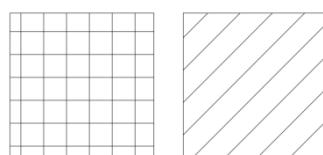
Marcação de pavimentos e coberturas, respetivamente
